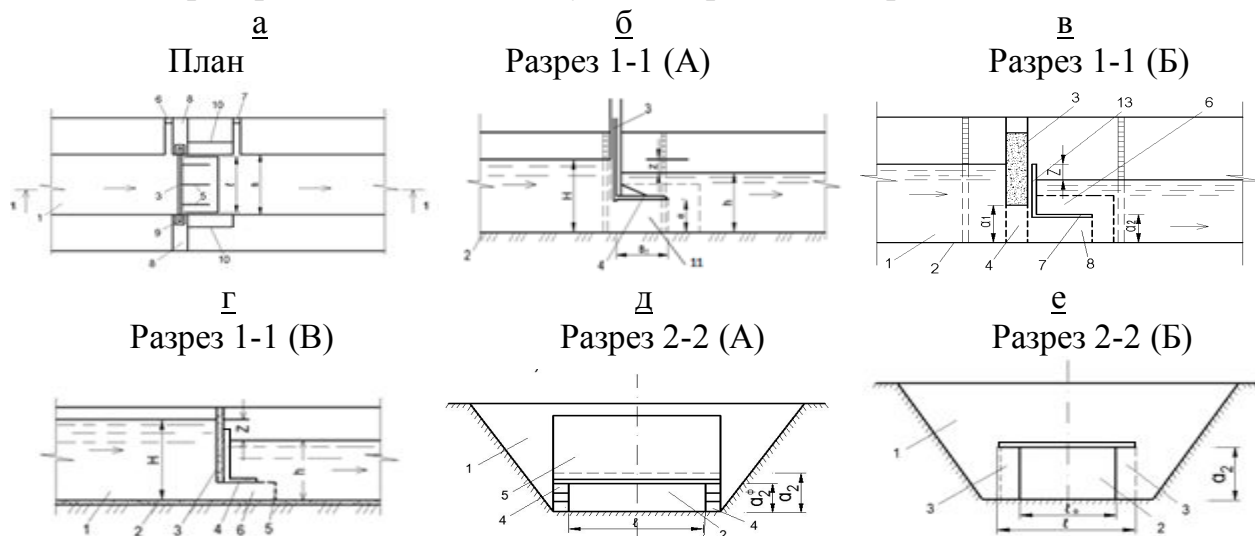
Схемы разновидностей водомера типа «Прямоугольный насадок» применительно к каналам с трапецидальным сечением.
